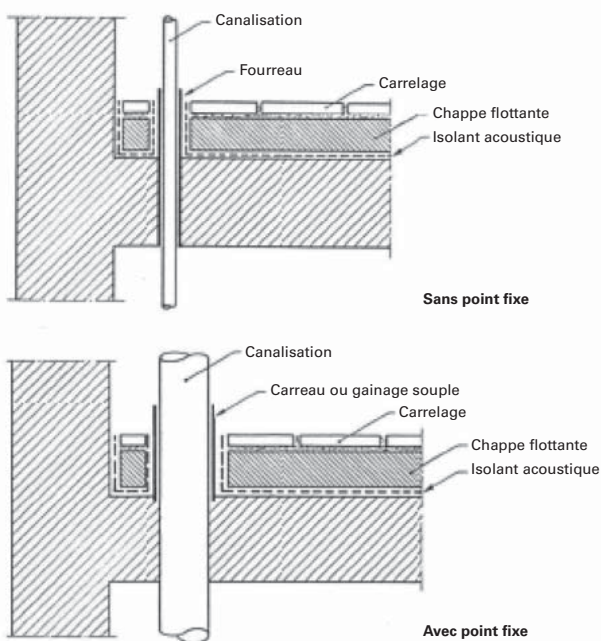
Canalisation entourée d'un fourreau ou d'une bande compressible dans la traversée
